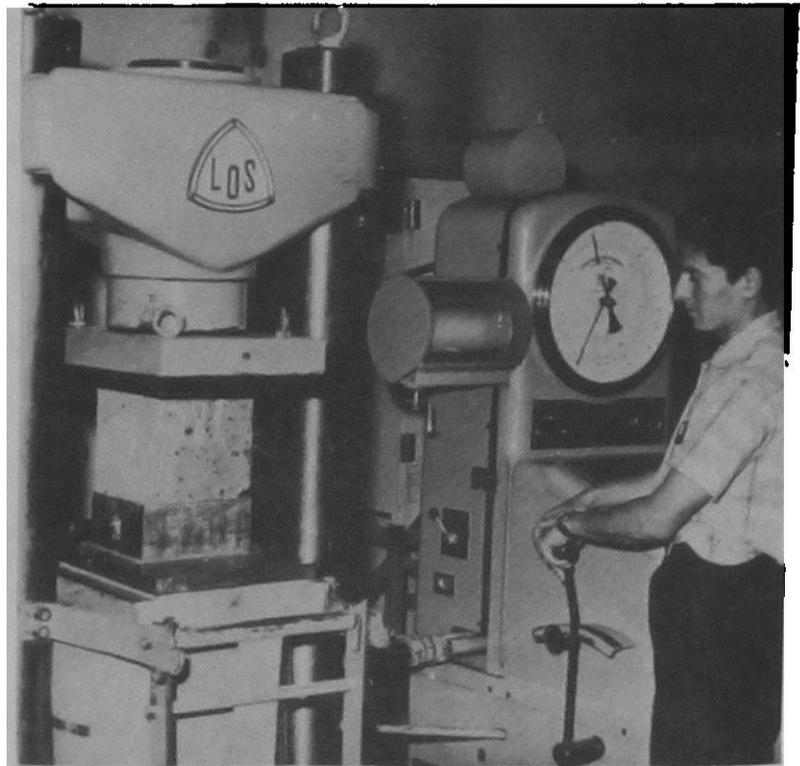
Ensayo de un cubo de hormigón a la compresión.
